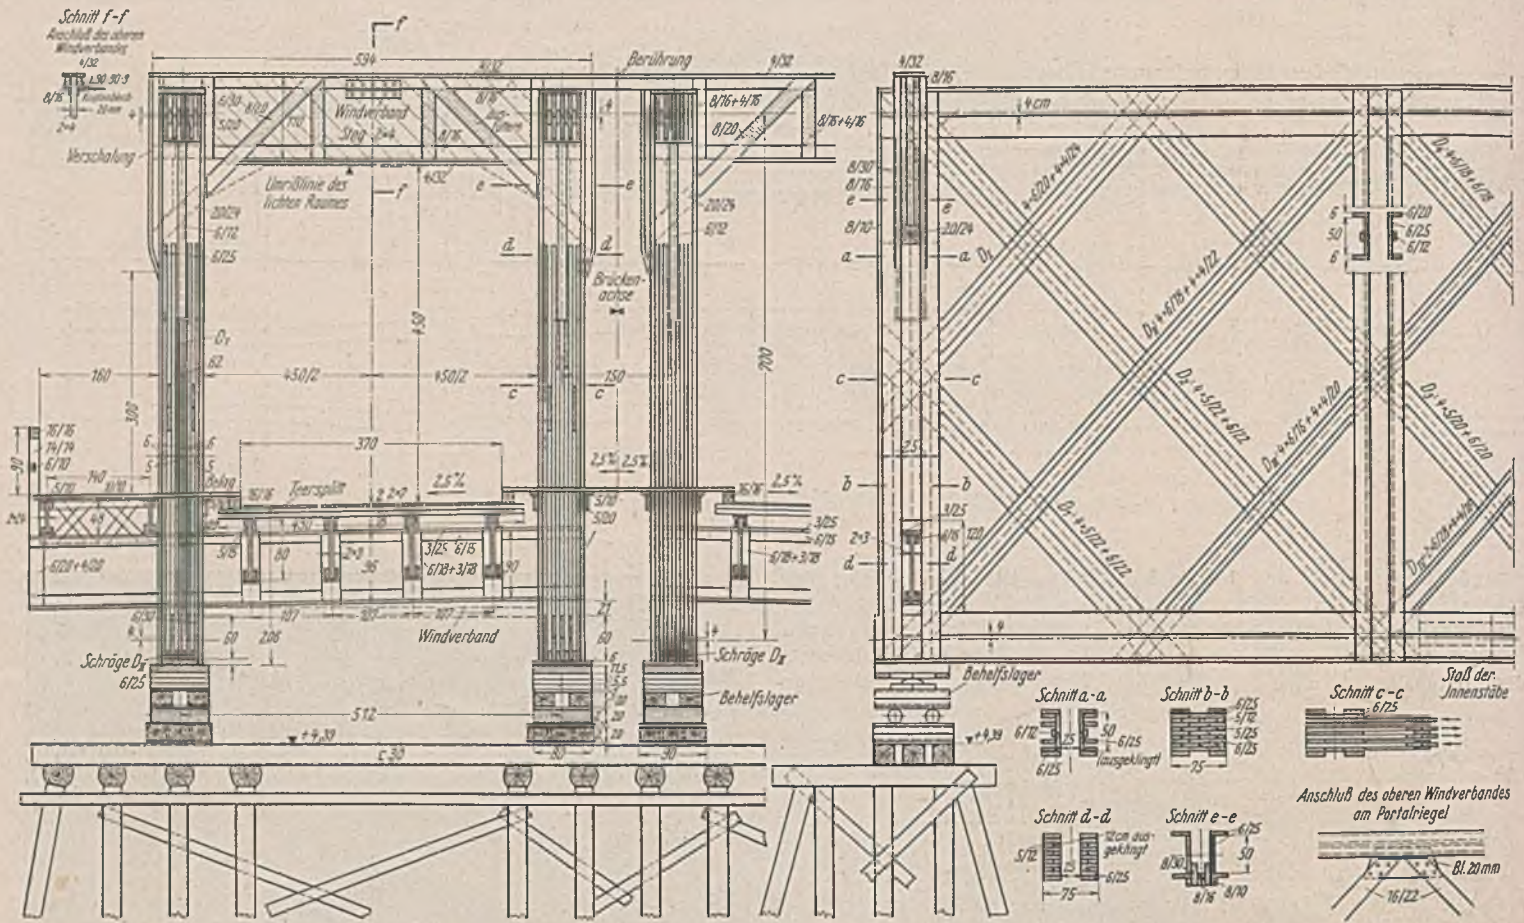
Querschnitt der Fachwerkbrücken mit einer Stützweite  $l = 50$  m. Ansicht des Endrahmens.
